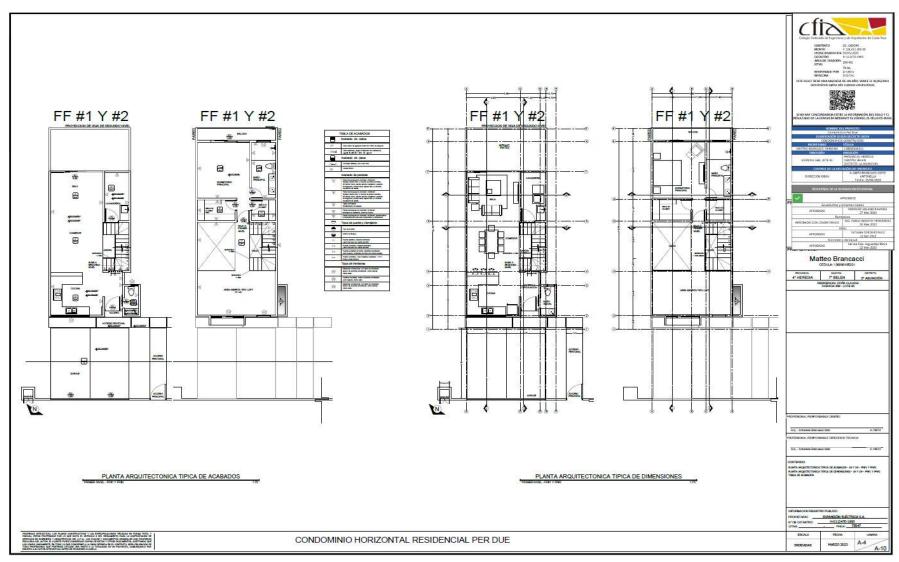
Distribución Arquitectónica. Fuente lámina constructiva # A-4.
